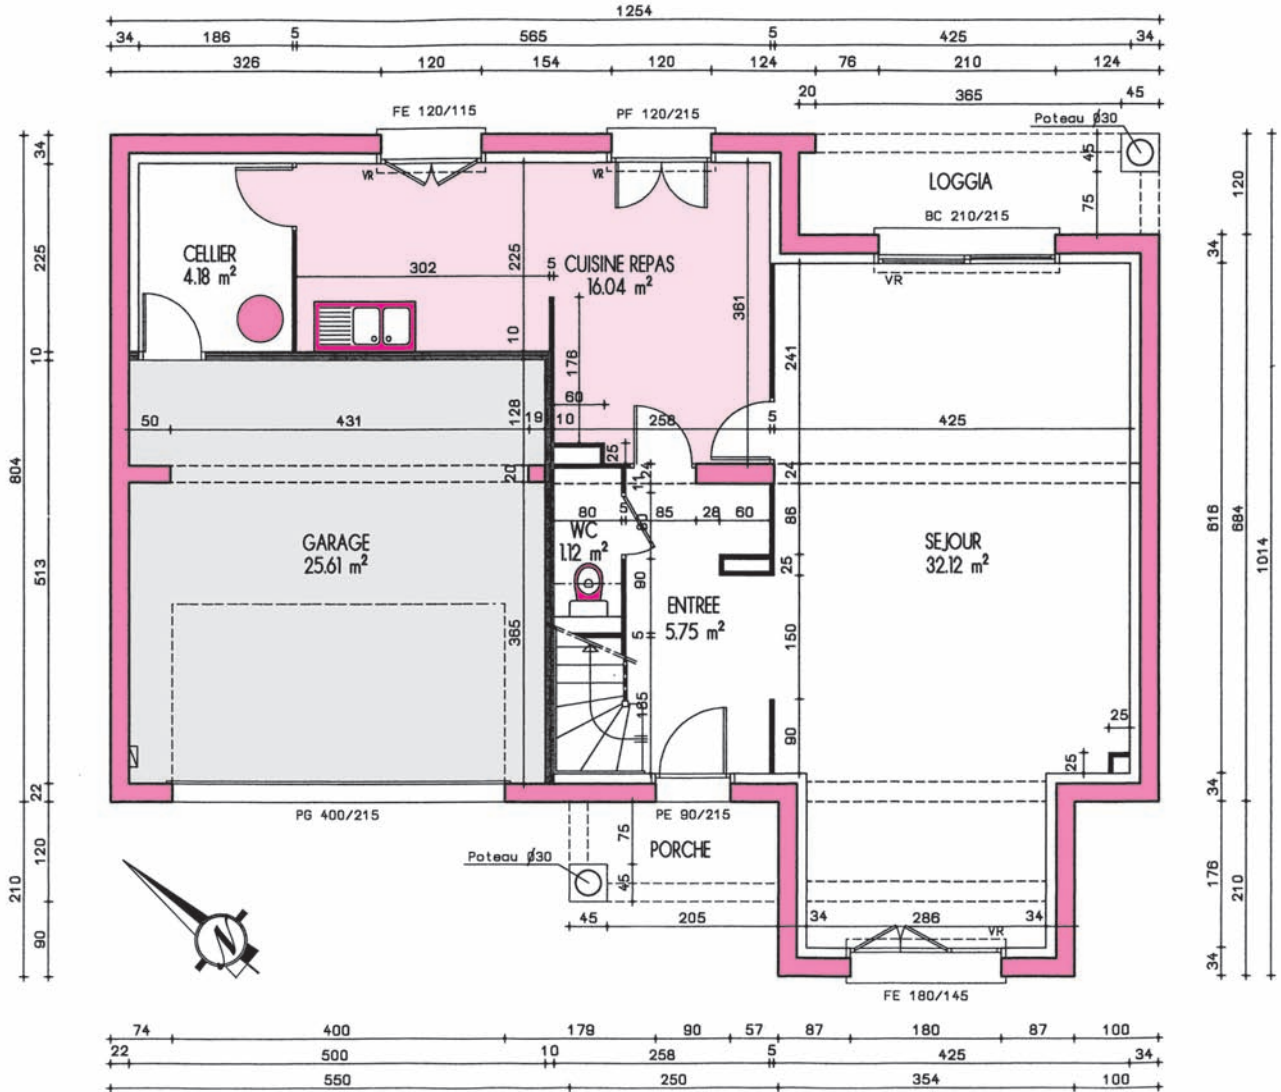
Plan d'exécution du rez-de-chaussée sur VS avec cotation
